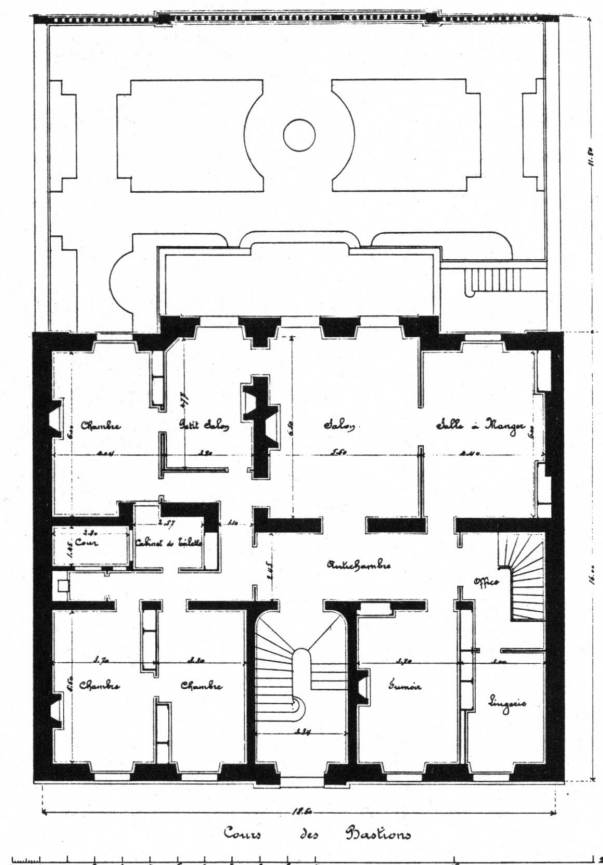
Cours des Bastions n° 6. Plan du rez-de-chaussée.
